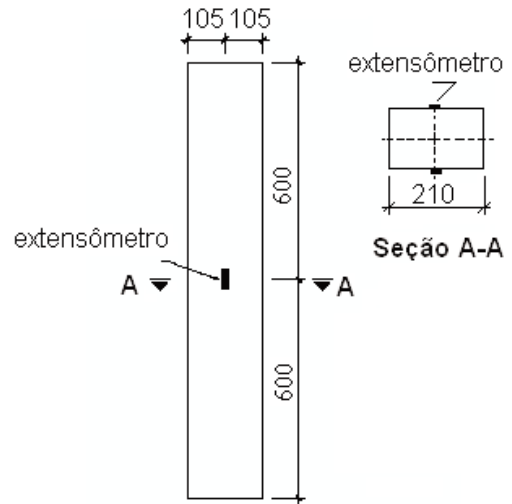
Posição dos extensômetros no concreto (dimensões em mm)
